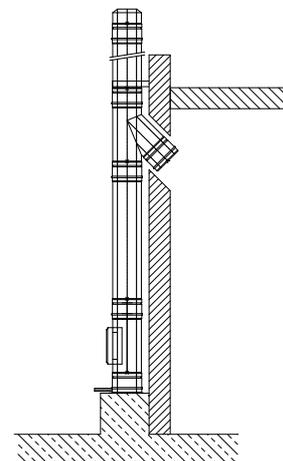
Aufbau mit Grundplatte für Sockelmontage
